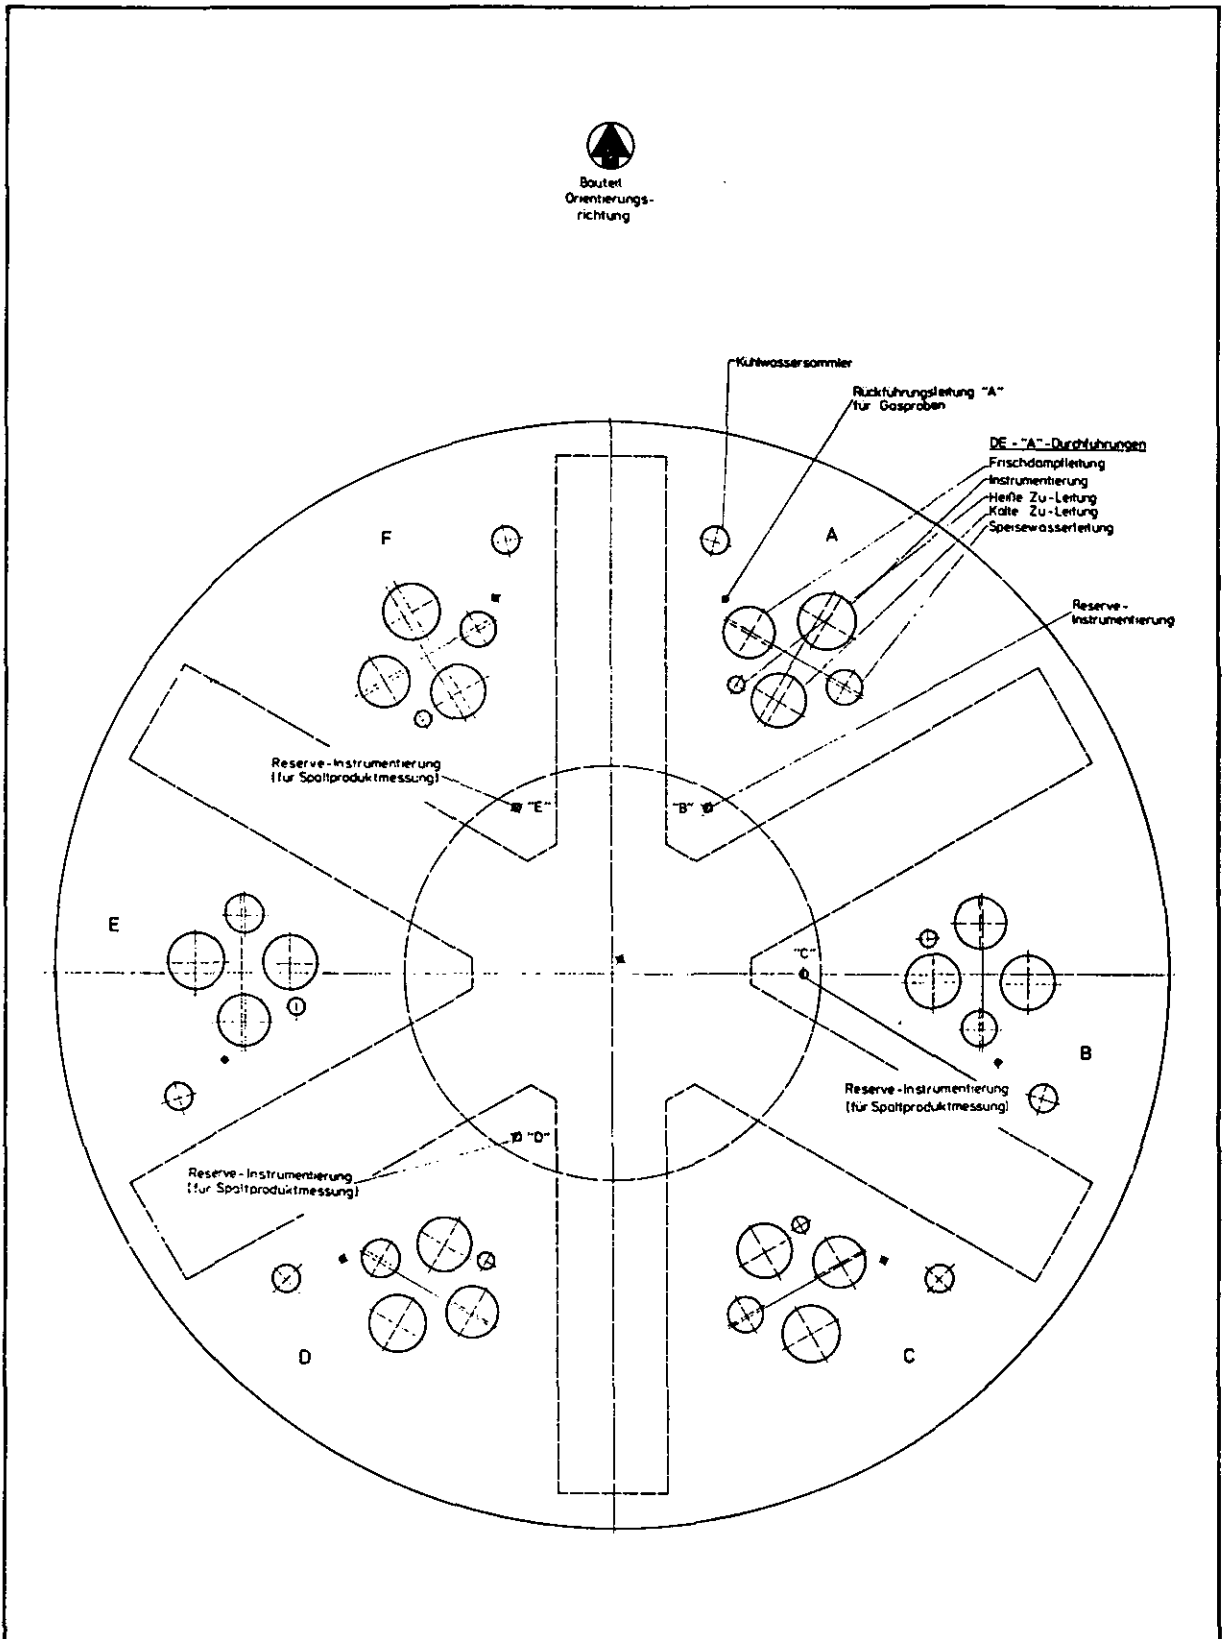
Spannbetonbehälter (Schnitt durch den Behälterboden)
